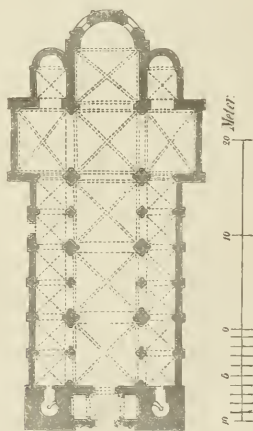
S. Fides zu Schlettstadt. Grundriß.
